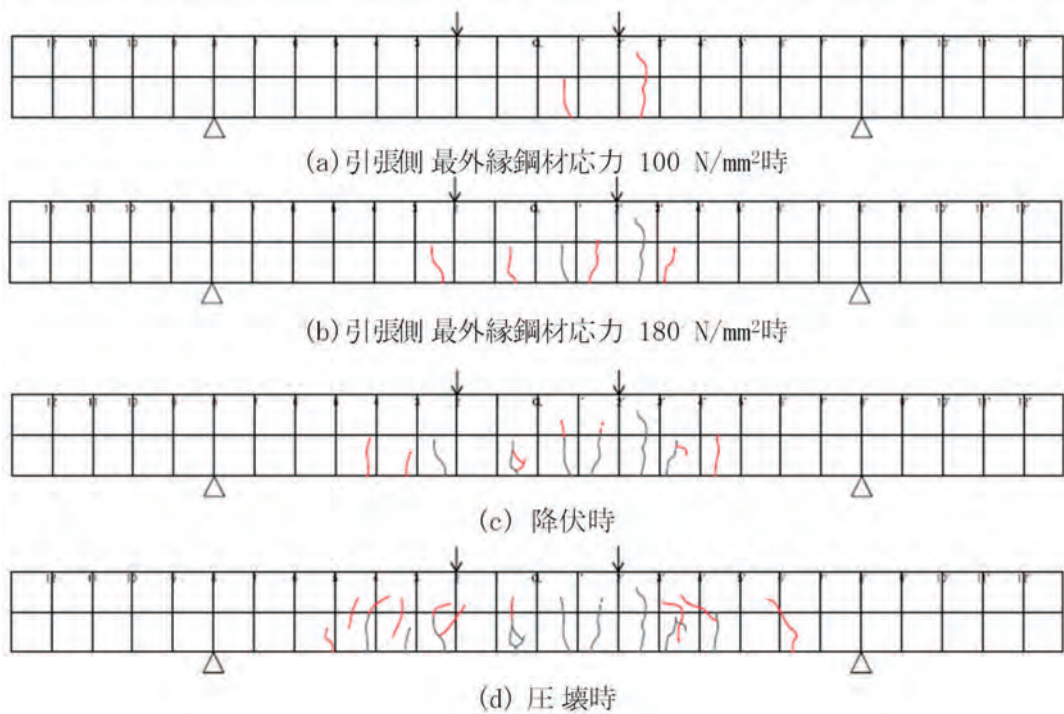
载荷に伴うひび割れの進展状況 (試験体 6a, 6b)
